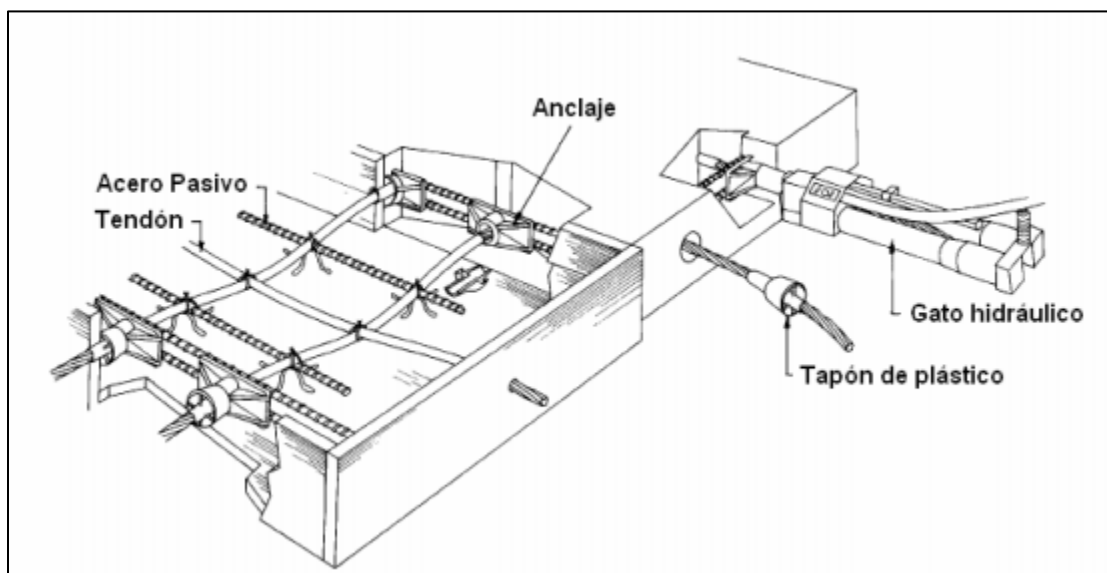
Eschema de colocación de armaduras activas y pasivas
